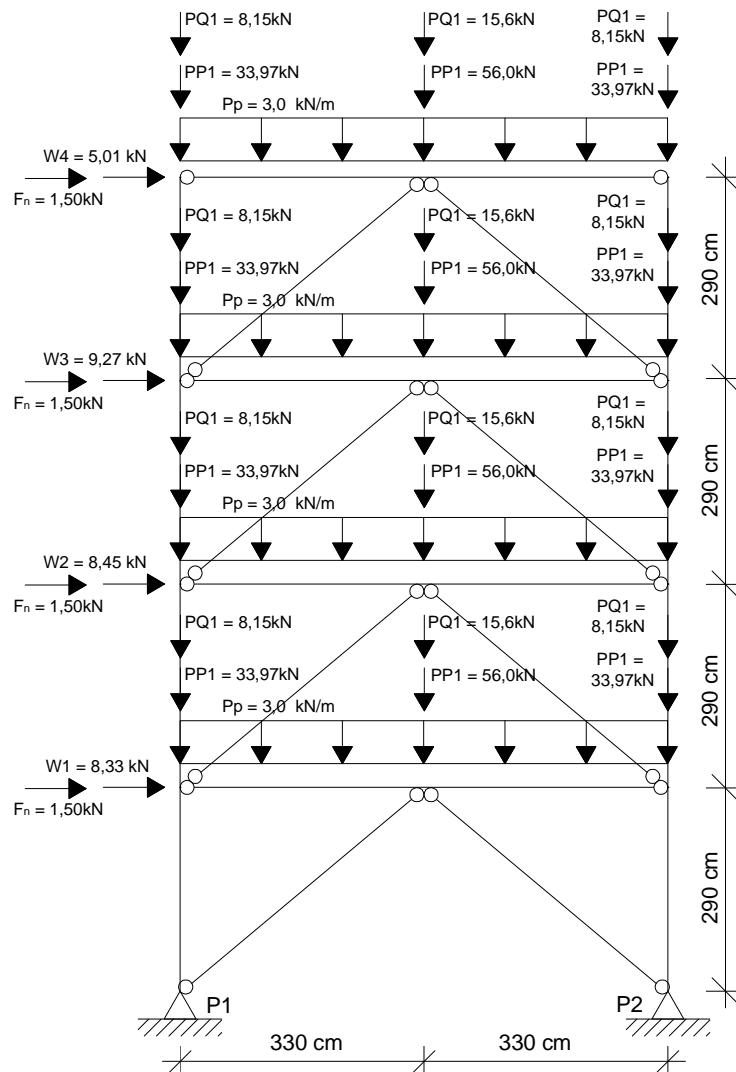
Pórtico contraventado de quatro pavimentos, com as ações aplicadas com seus valores característicos.
